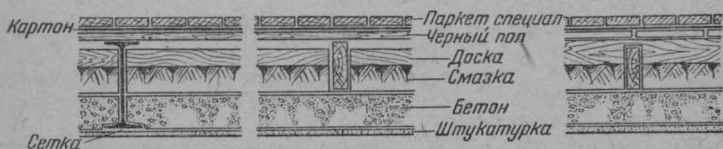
Междуэтажное перекрытие с бетонным заполнением между металлическими балками.
